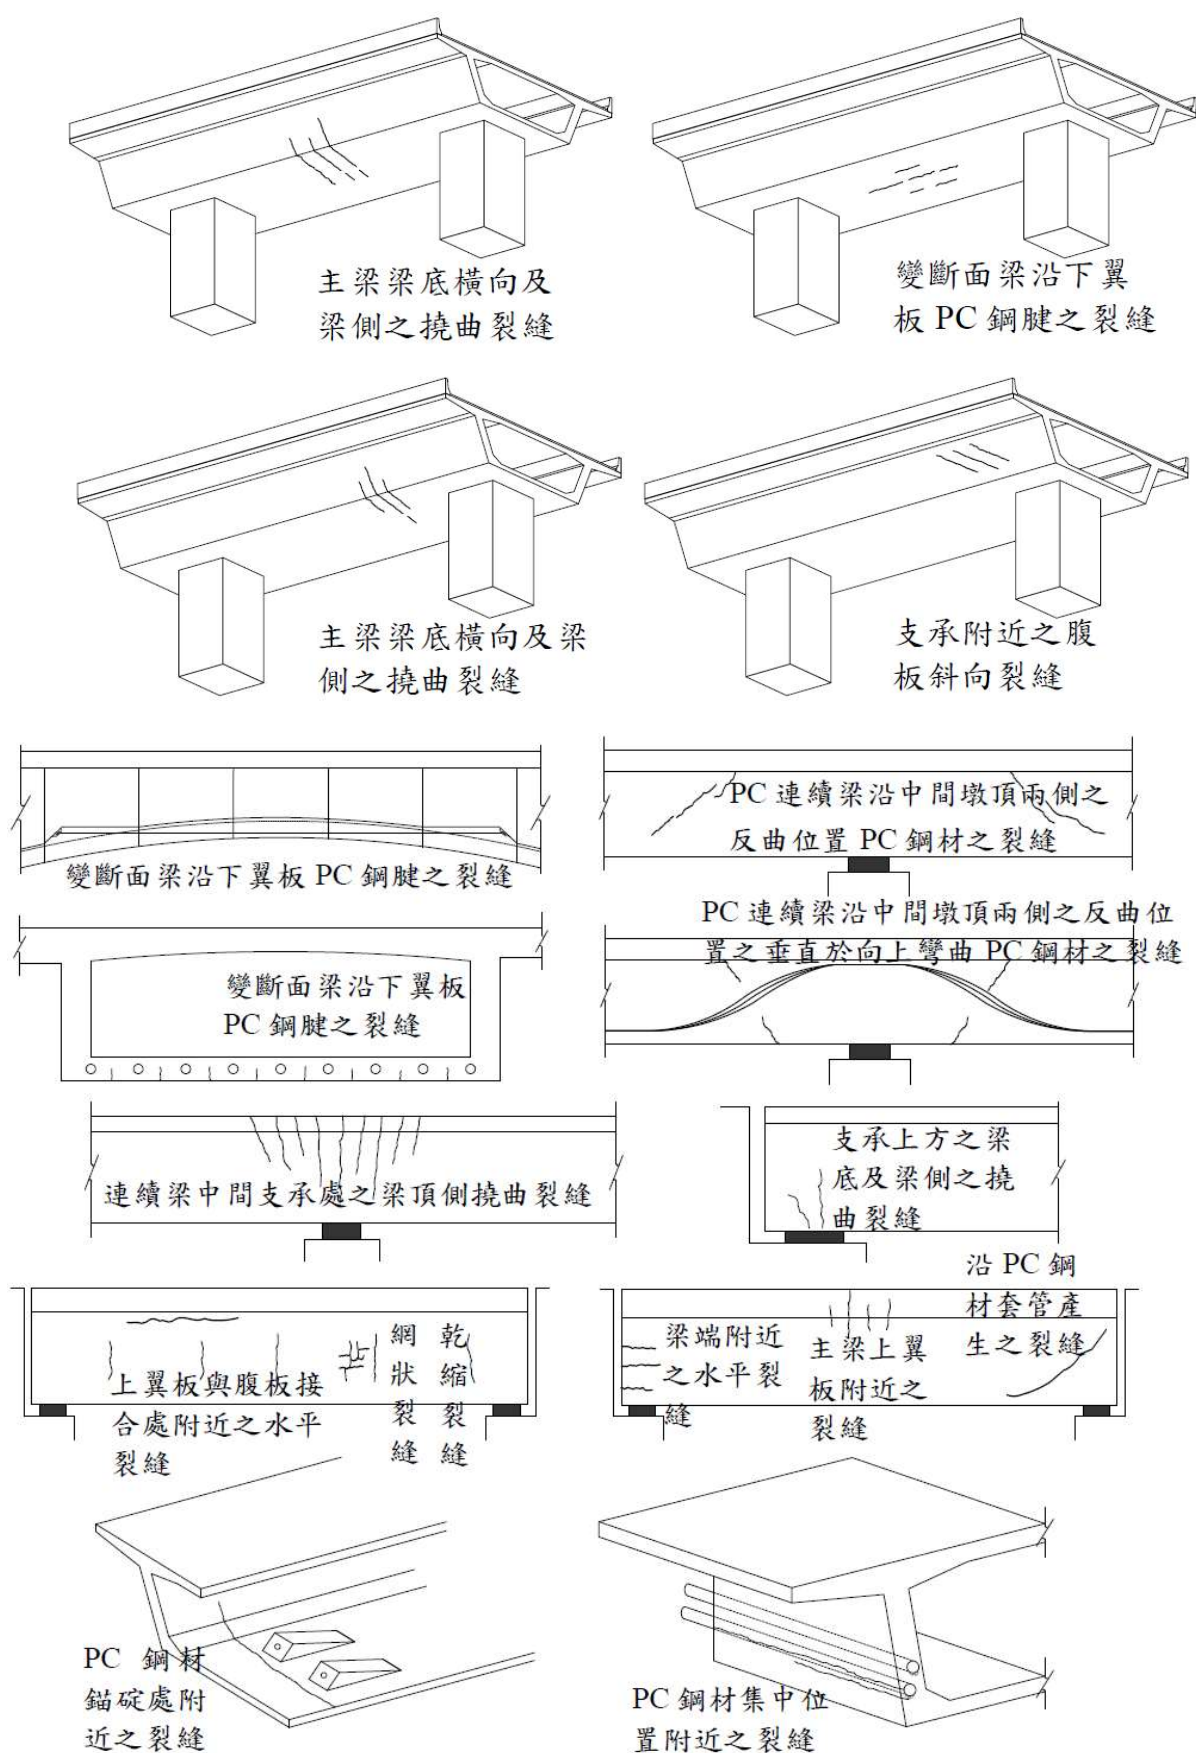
預力混凝土箱型梁裂縫示意圖
